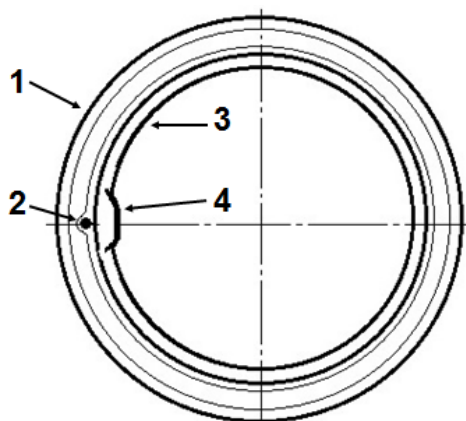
Корпус чугунного люка по ГОСТ 8591-76, вид сверху:
